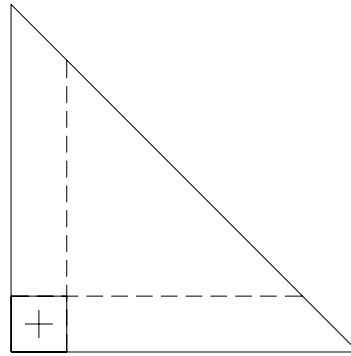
Planta de la zapata triangular con las dos vigas laterales
